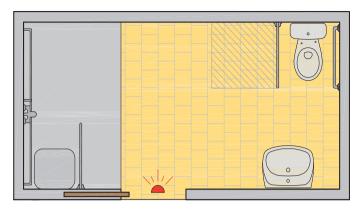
Planta de un aseo accesible con ducha enrasada.
